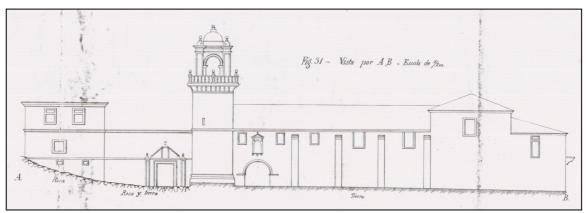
Acceso primitivo desde la Fachada Sur, 1897.
